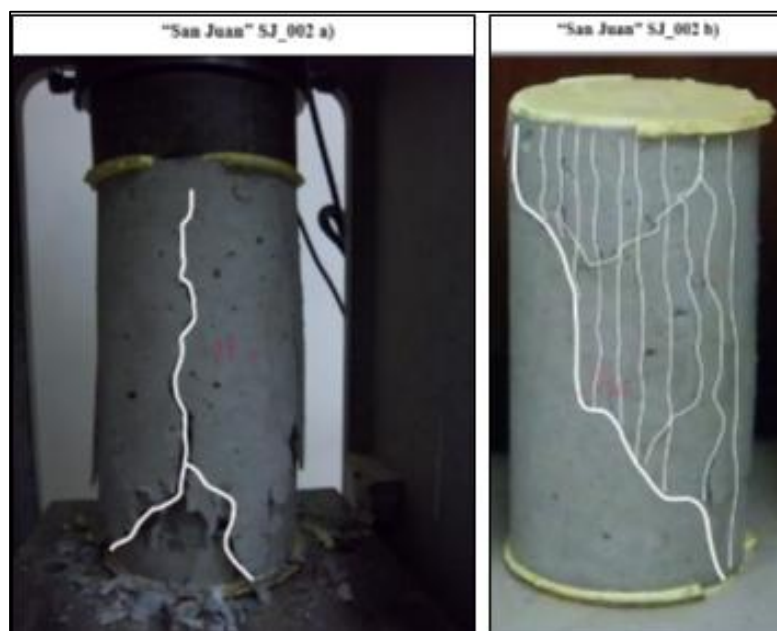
Rotura de fallas. a) tipo 2 y b) tipo4.
